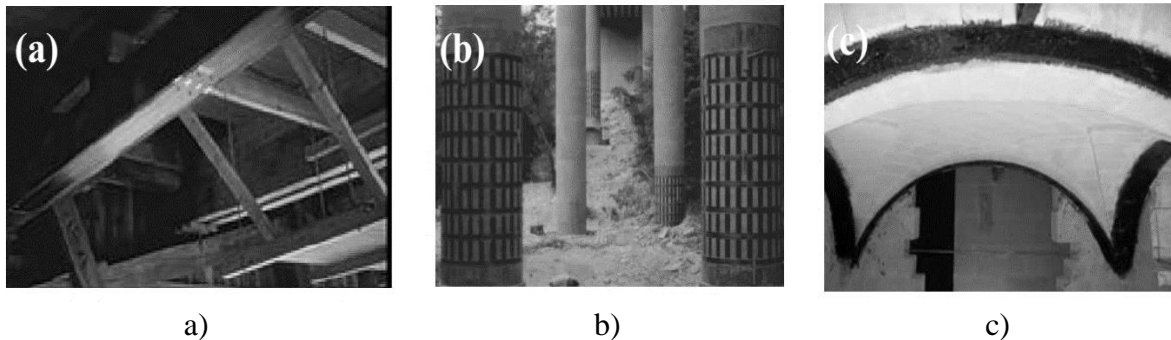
Exemplo de aplicação de FRP como reforço exterior: a) Madeira; b) Betão; c) Alvenaria (Maruccio, 2010).
